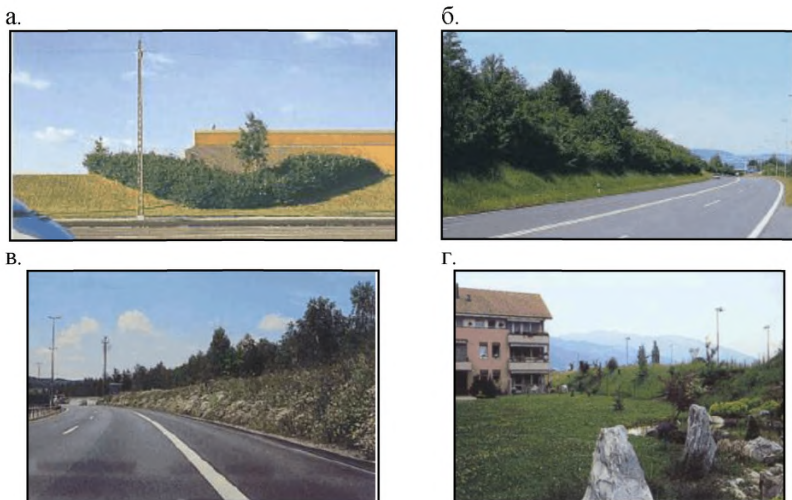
Внешний вид шумозащитного вала со стороны проезжей части (а, б, в) и со стороны защищаемой территории (г)
